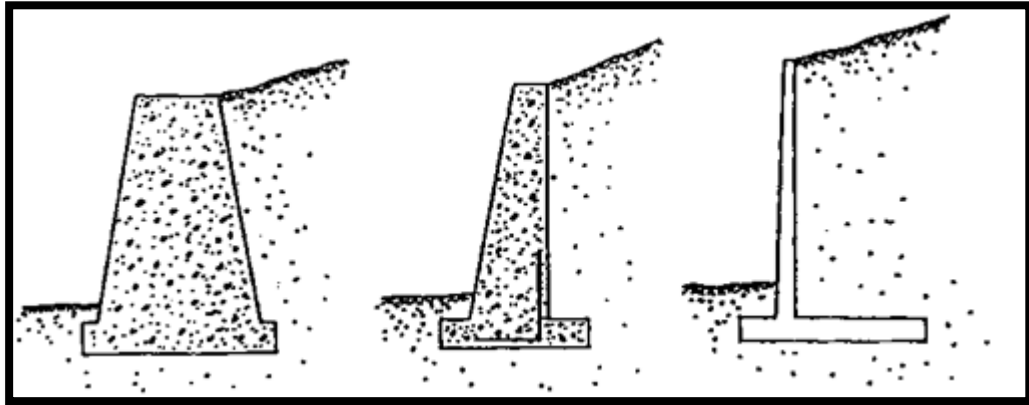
a) Muro de gravedad b) Muro de semigravedad c) Muro en Cantiléver
